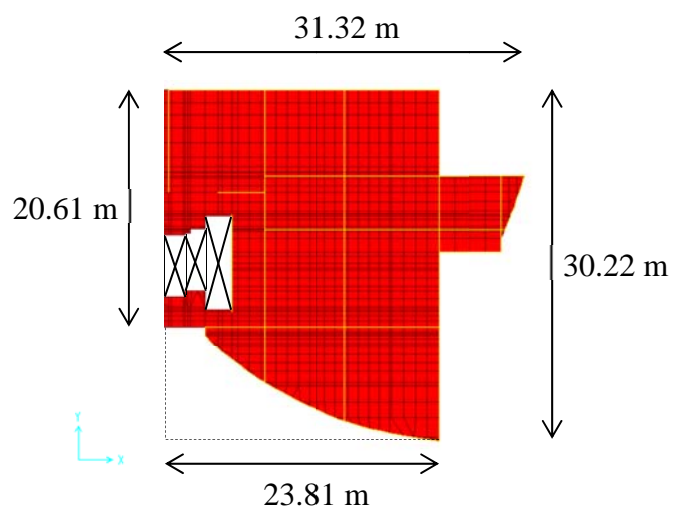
Dimensiones de la Planta Cielo Primer Piso (S/E).
